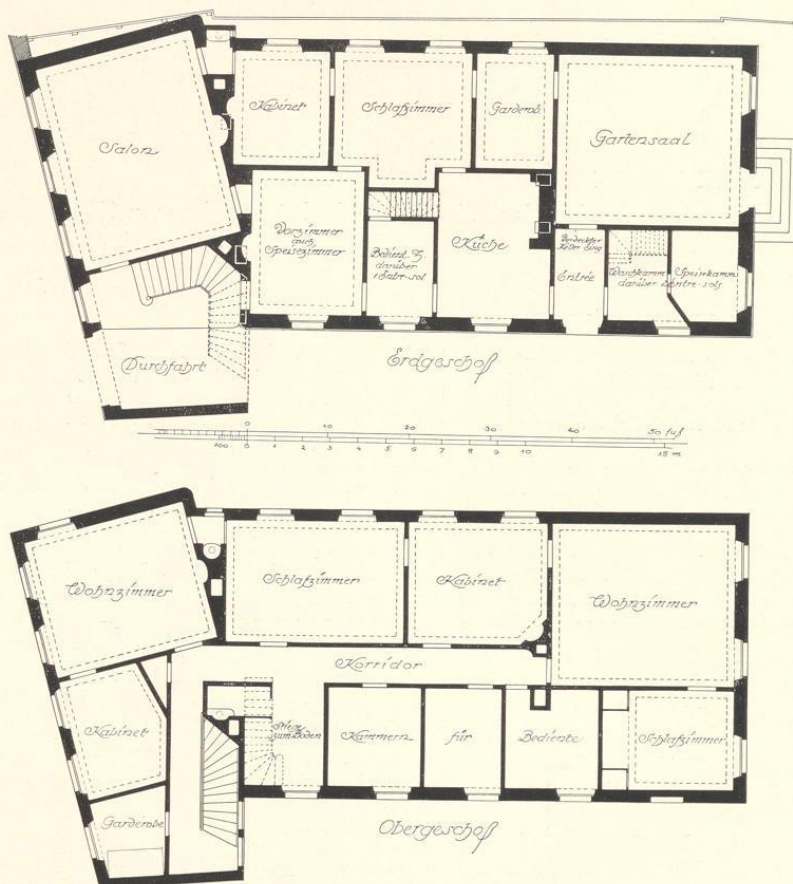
und 294. Grundrisse des Erd- und Obergeschosses der Siegelkammer nach den Plänen Lippers, 1793
